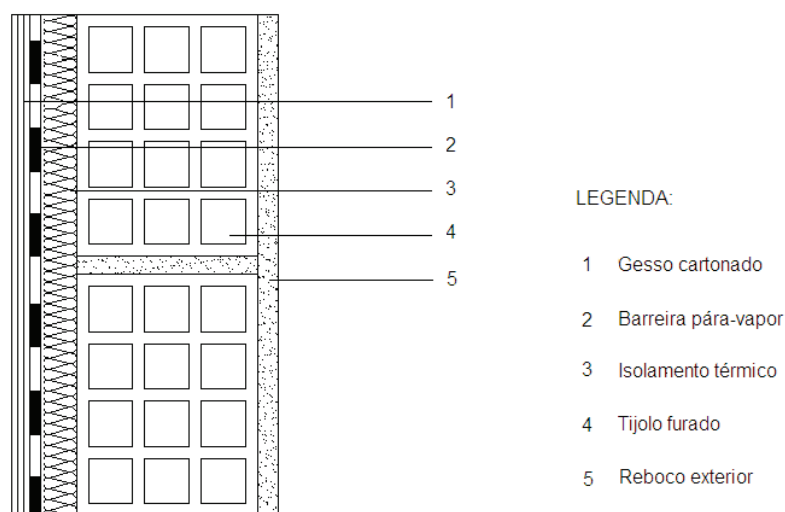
Pormenor construtivo da colocação da barreira pára-vapor, na parede simples com isolamento térmico pelo interior.
